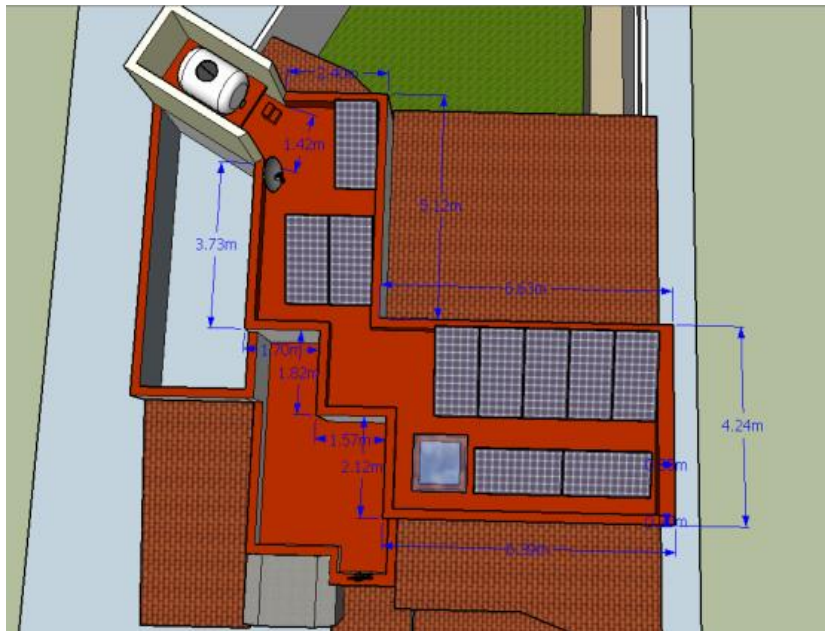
Plano 3D, vista de planta: aporte propio.
